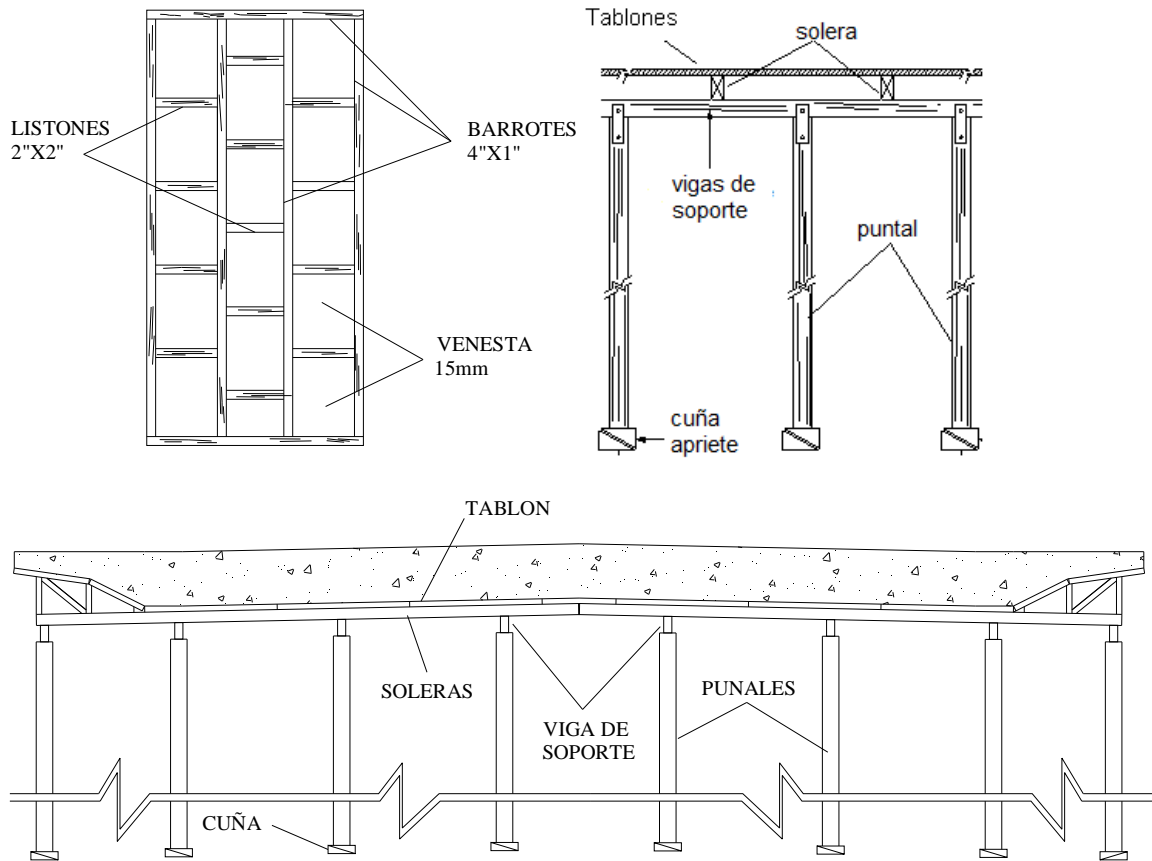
Esquema de encofrado de superestructura
